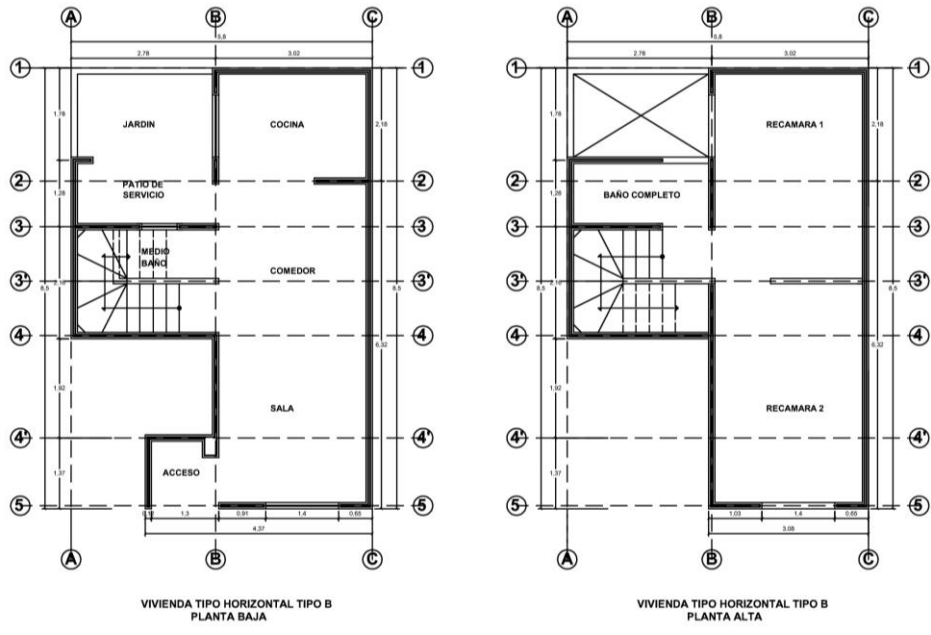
Planta Arquitectónica Vivienda Horizontal Tipo B, Fuente: (Autoría propia, 2019).
